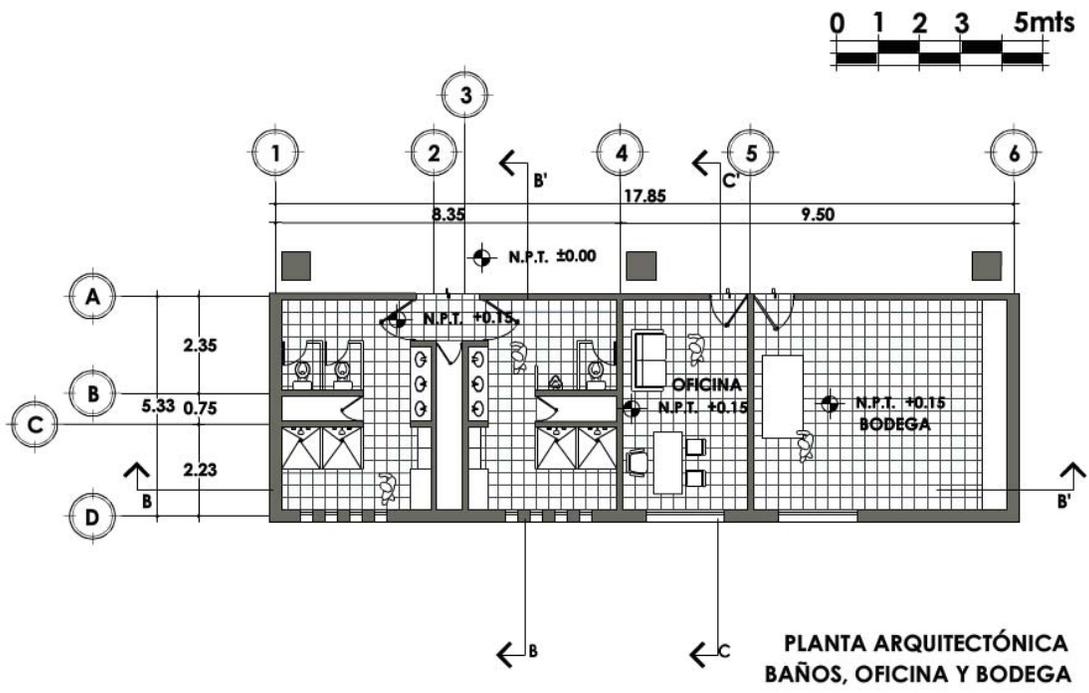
Planta arquitectónica, baños, oficina y bodega
